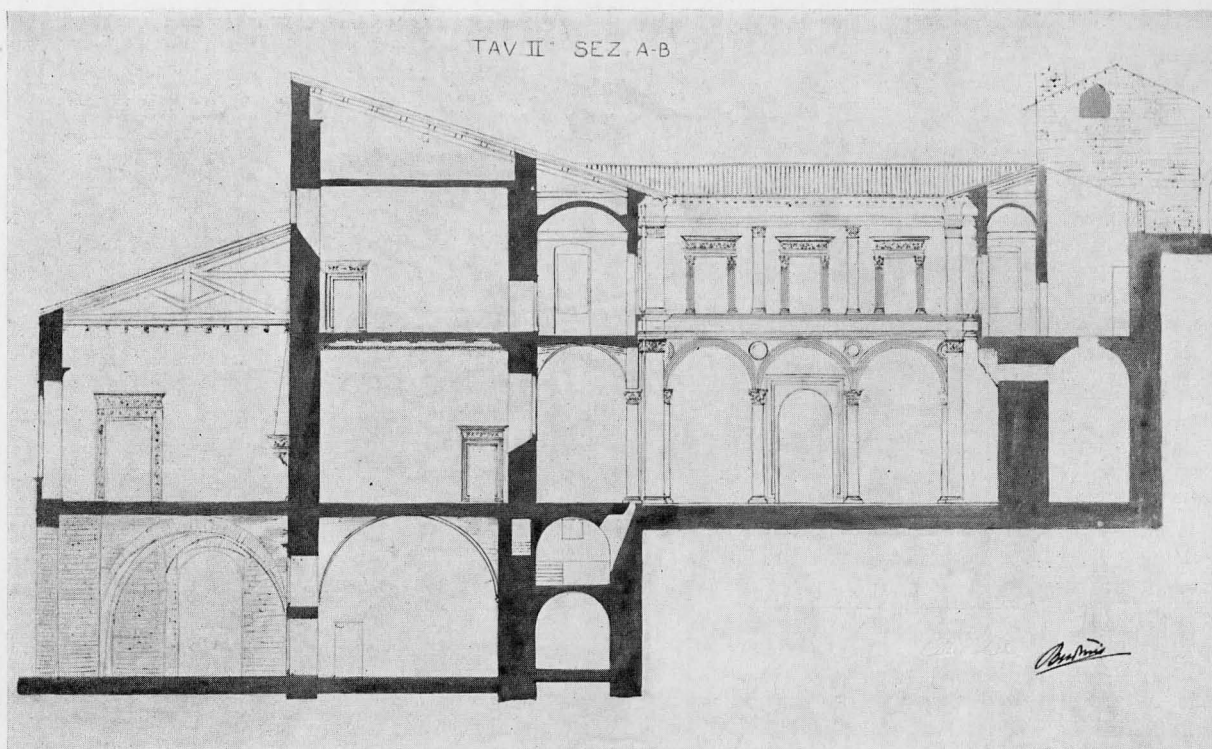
GUBBIO, PALAZZO DUCALE: SEZIONE
